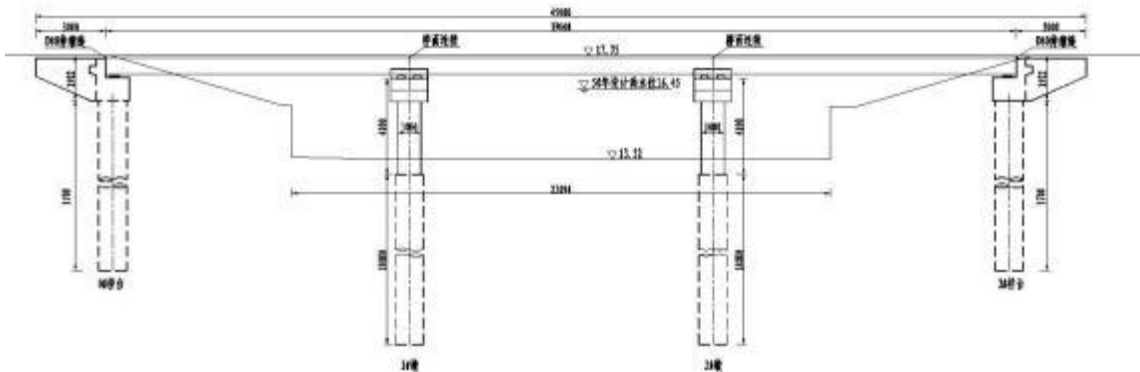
桥梁立面图（小拐交通桥、中庄桥）
